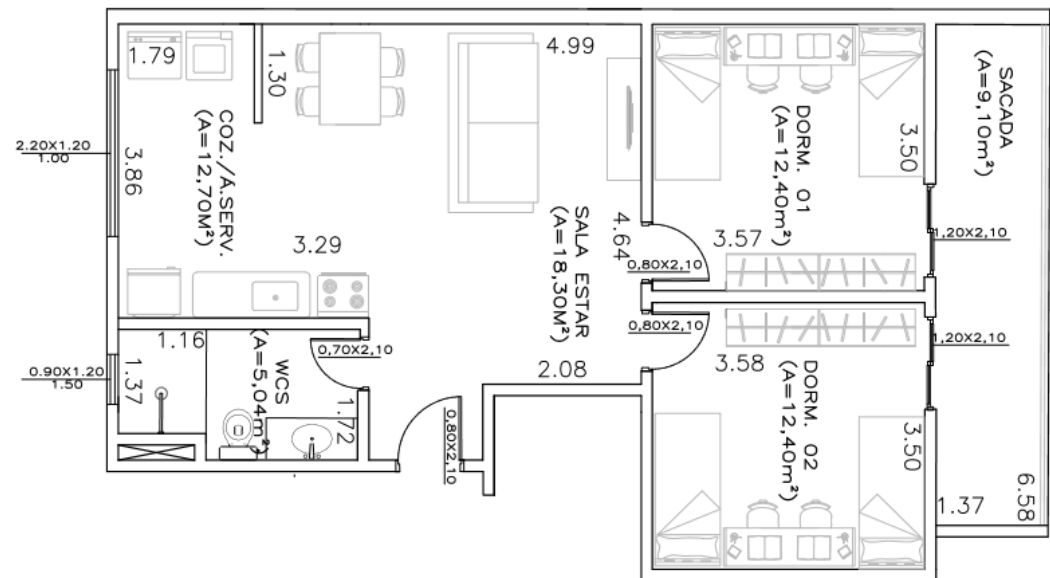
| Detalhe Planta de Estudos mais acessos- Fonte: Acervo
